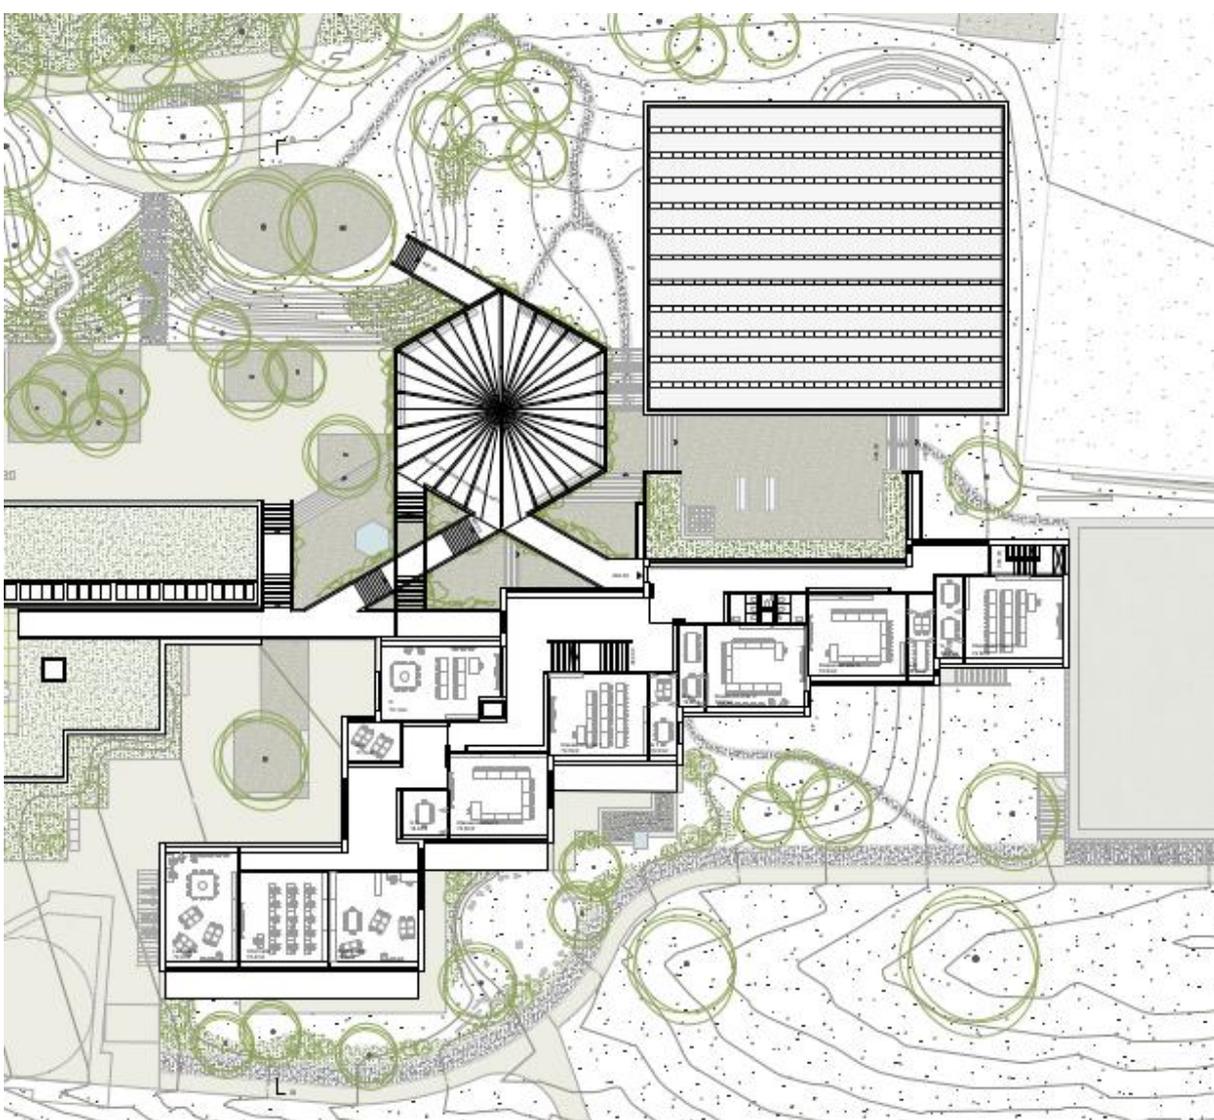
Grundrisse Dachaufbau Primarschule / 2. Obergeschoss Sekundarschule
